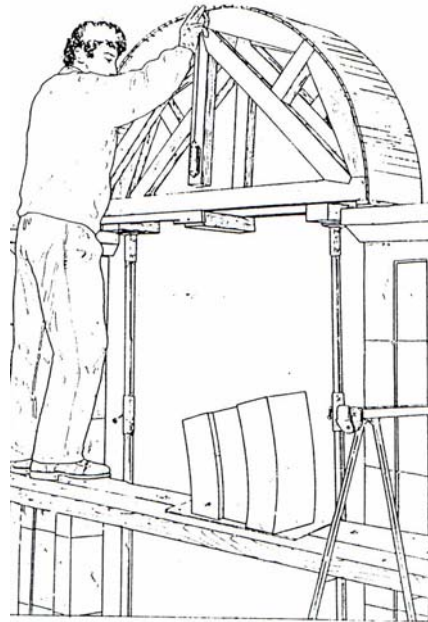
Colocación de la cimbra bien aplomada y provista de los elementos de descimbrado.
